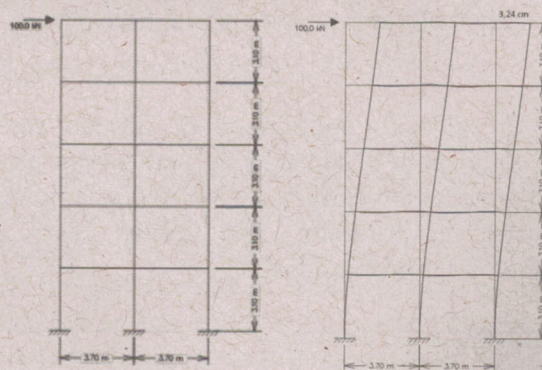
Modelo Estrutural com Carregamento Externo e Modelo Estrutural com 05 Pavimentos deformado
